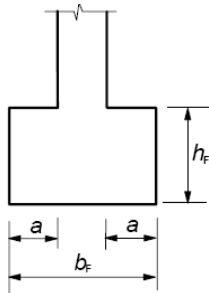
Unbewehrte Stützenfundamente; Bezeichnungen
